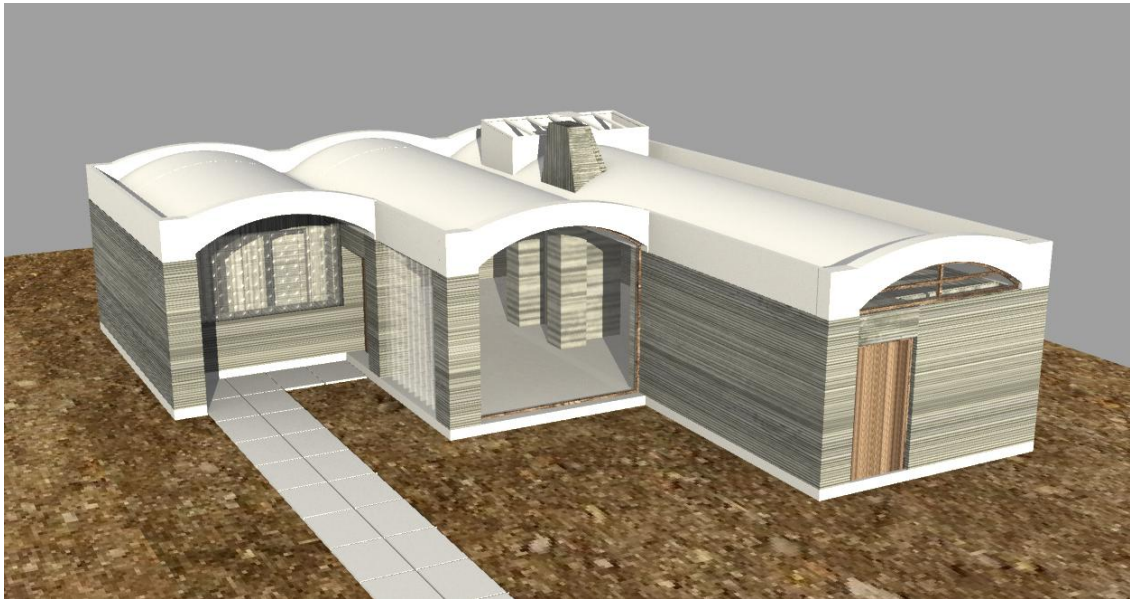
Edificio acabado con construcción aditiva (fuente propia)
